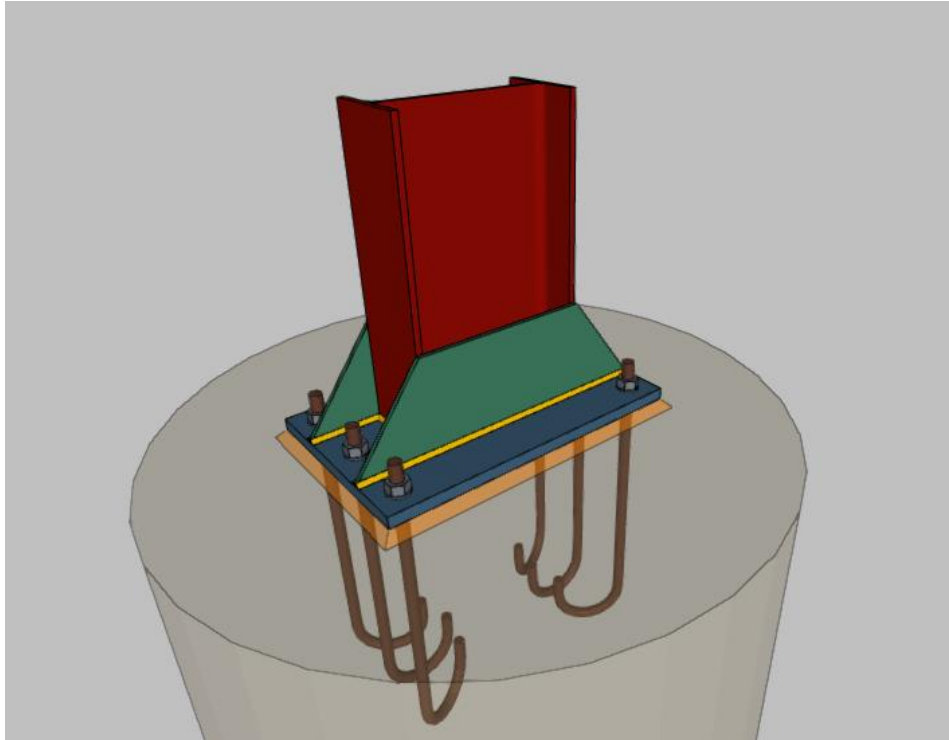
Unión pilar - zapata atornillada [7].
